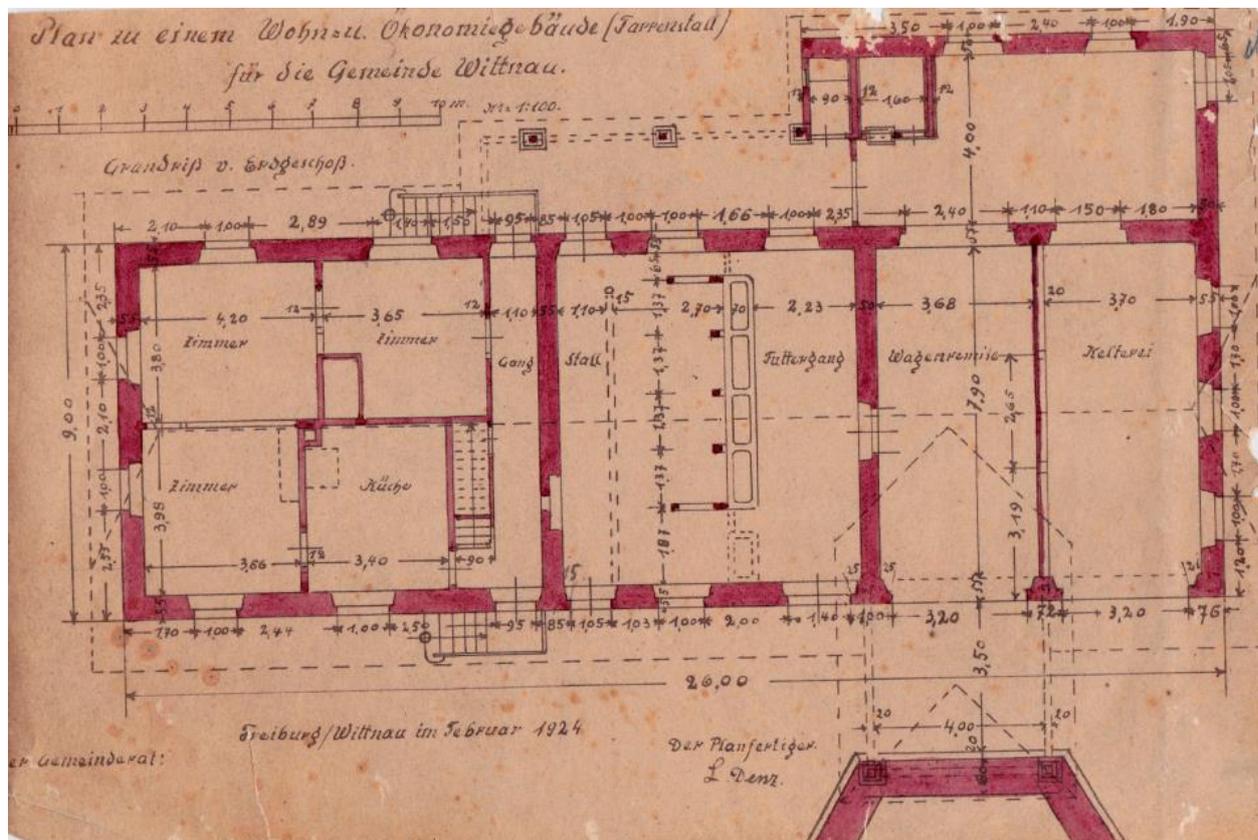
Grundriss vom Erdgeschoss; Quelle: Archiv der Gemeinde Wittnau
